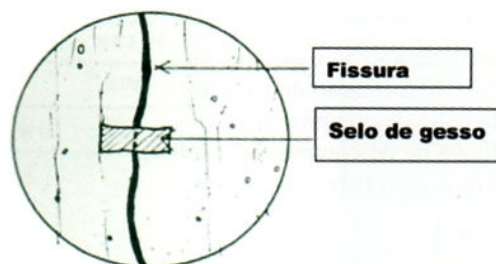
Modelo de fissurômetro (FIGUEIREDO, 2005, p. 1013).
